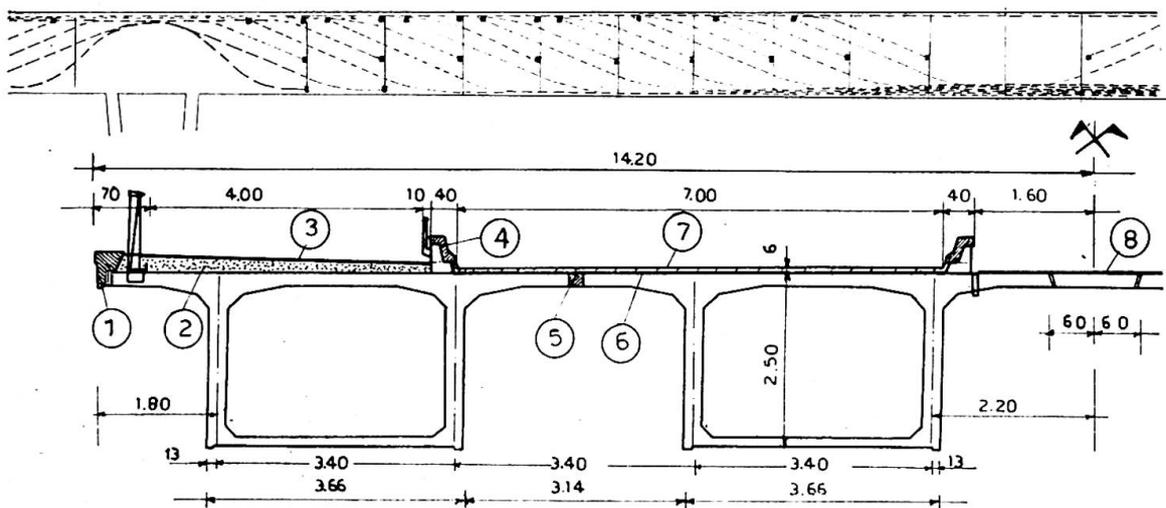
Pont à voussoirs de Choisy-le-Roy. En haut = plan de couffrage. En bas = coupe transversale type: 1, Corniche préfabriquée en b. a. - 2, Béton de forme - 3, Revêtement d'asphalte - 4, Bordure glissière préfabriquée - 5, Joint coulé sur place - 6, Revêtement bitumineux - 7, Chape d'asphalte - 8, Dalle de raccordement entre les 2 Tabliers.
